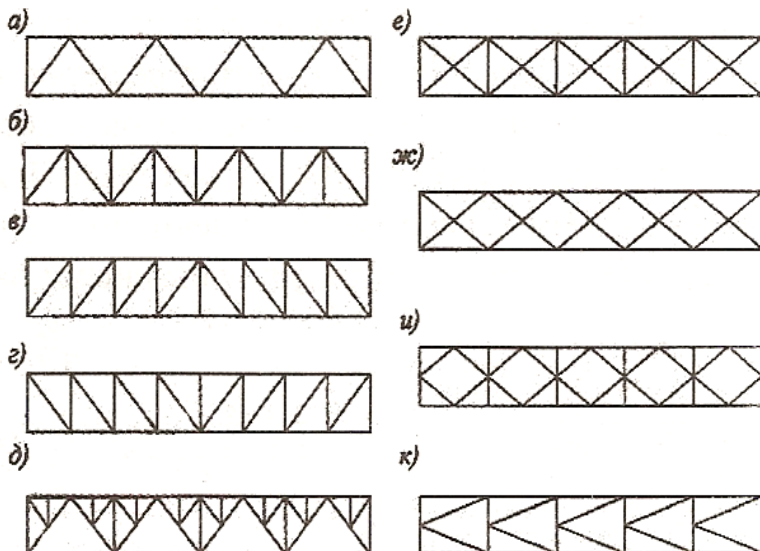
Схемы решеток ферм: а) треугольная; б) треугольная со стойками; в, г) раскосная; д) шпренгельная; е) крестовая; ж) перекрестная; и) ромбическая; к) полураскосная
